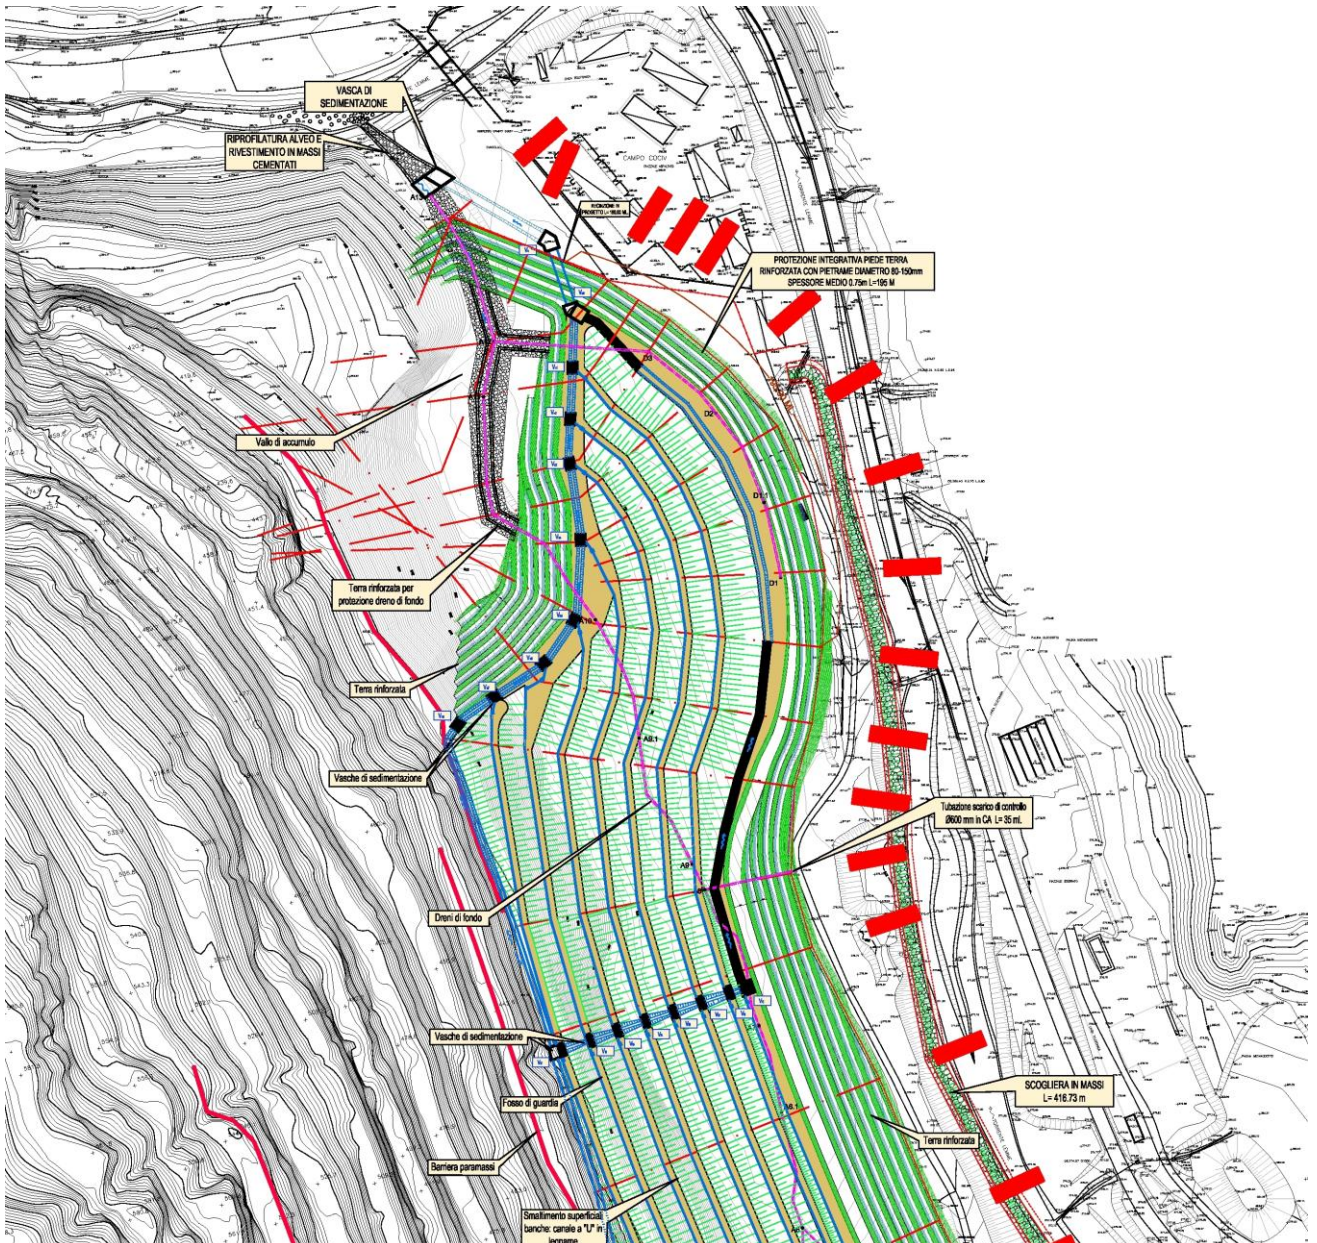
Planimetria con ubicazione della vasca di accumulo
